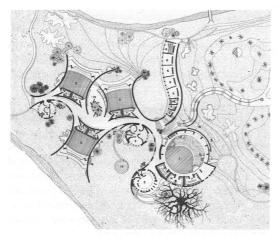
Planta definitiva de la Escuela de Ballet (Archivo personal de Vittorio Garatti)
